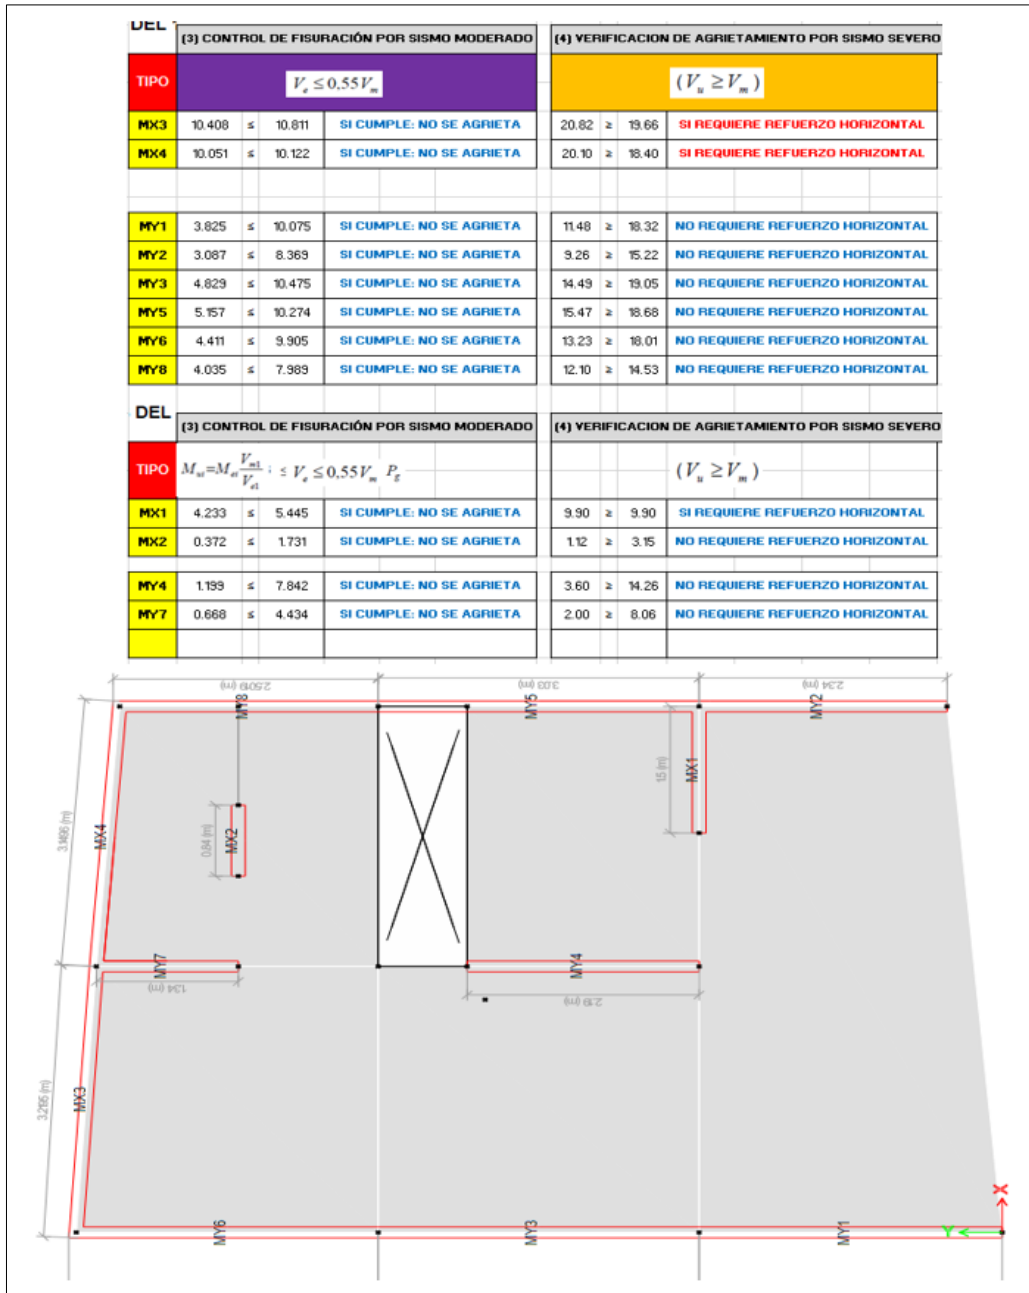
Control de fisuración por sismo severo y moderado de la vivienda 02
